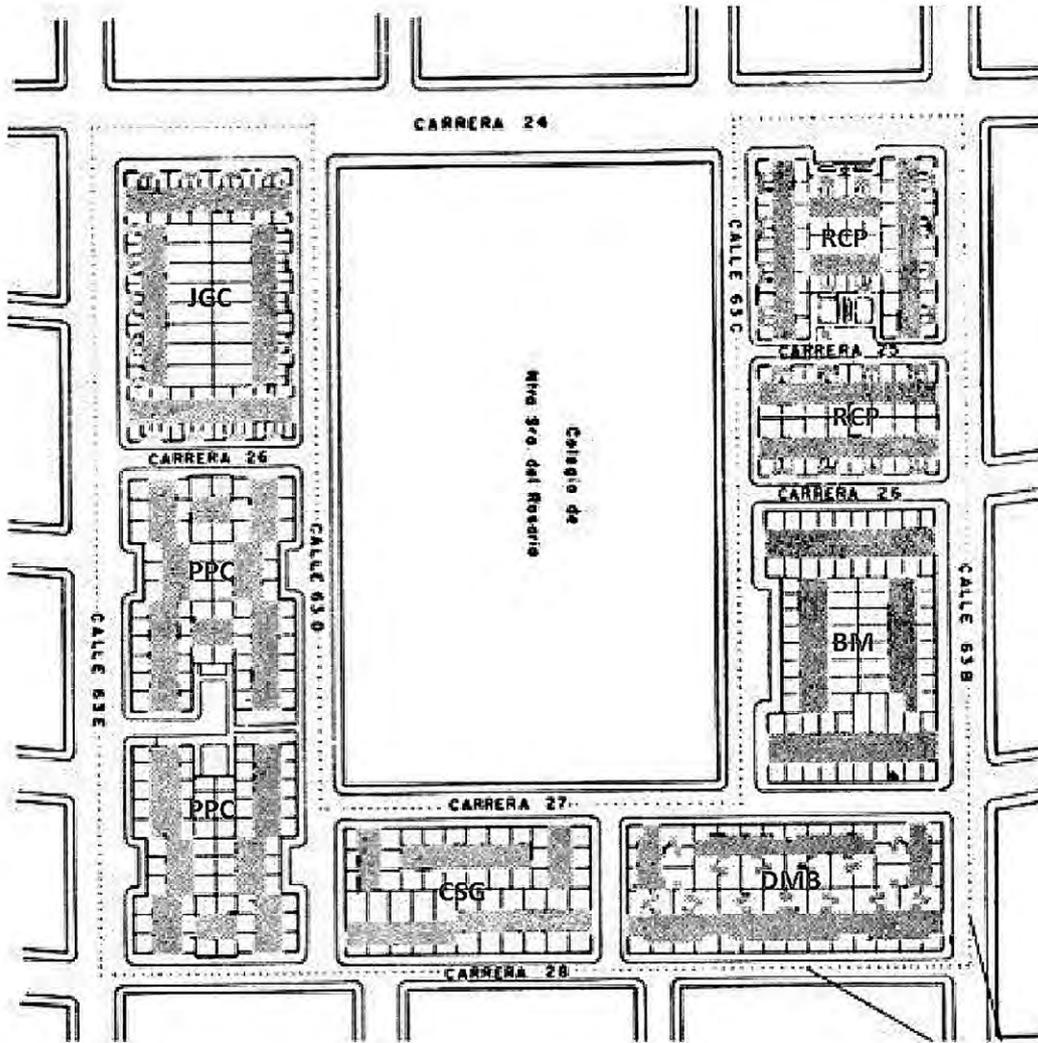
Plano de localización casas Quinta Mutis. Revista PROA, (noviembre, 1955) 94, s.p.
